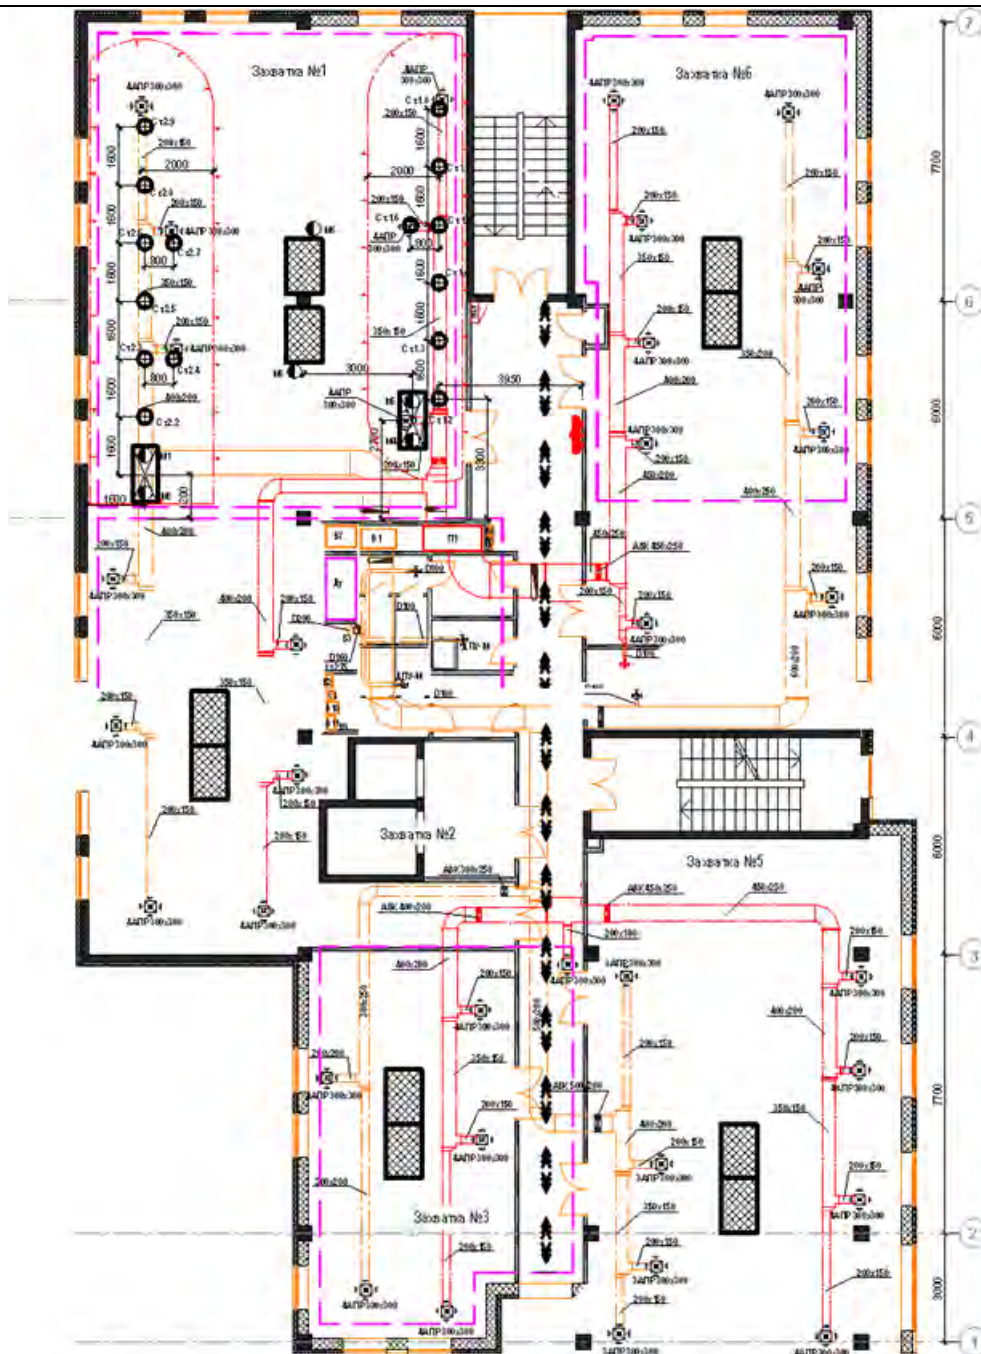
Схема монтажа системы приточных и вытяжных каналов и оборудования. М 1:100
